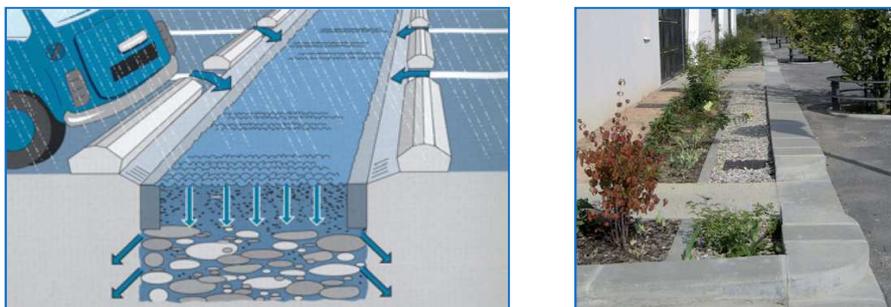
SCHEMA D'UNE TRANCHEE DRAINANTE (A GAUCHE) [65] ET TRANCHEE D'INFILTRATION A LYON (A DROITE) [66]
